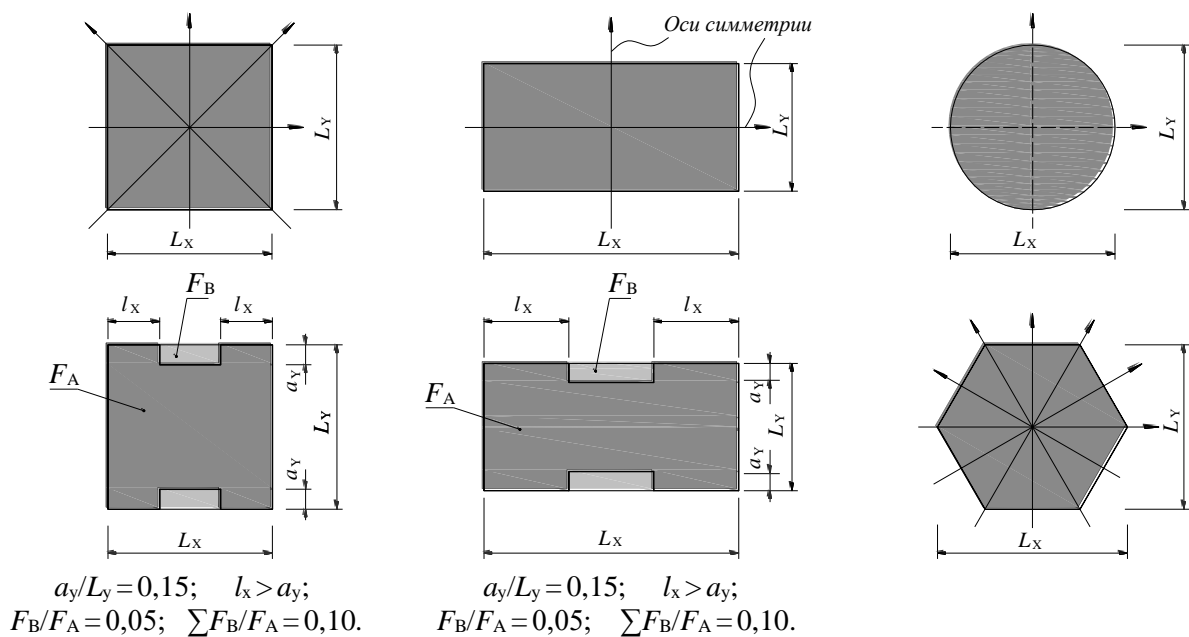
Перекрытия с проемами, не соответствующие условию 3.2.1.3.2 в)
